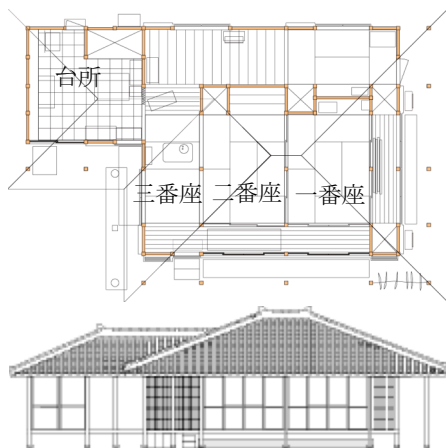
実測調査を行った伊是名民家の平面図及び南立面図（A家）
